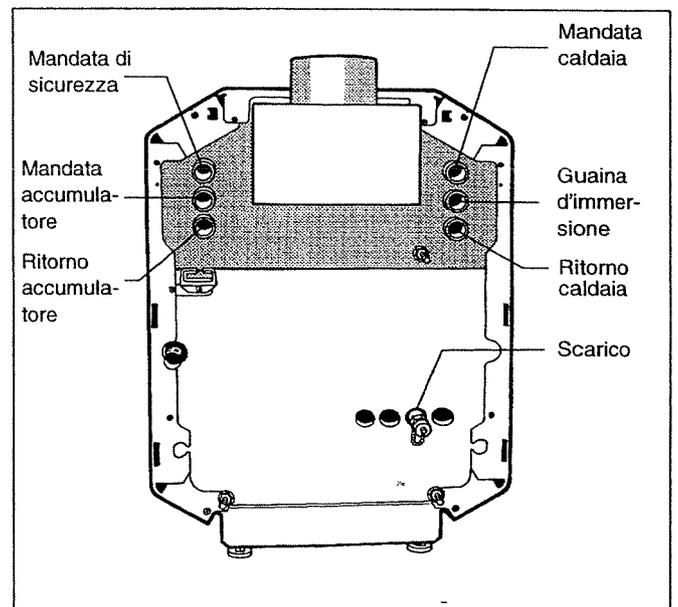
Collegamenti dopo lo spostamento della guaina di immersione e del tubo di collegamento della mandata accumulatore
